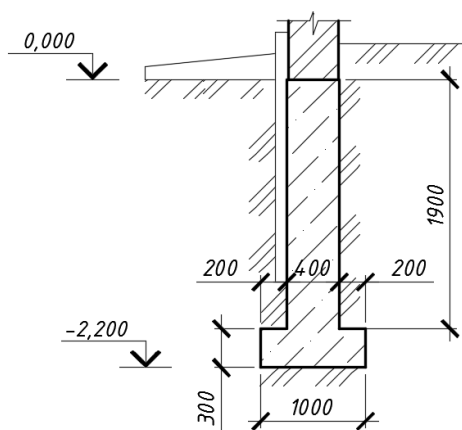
Монолитный железобетонный ленточный фундамент
